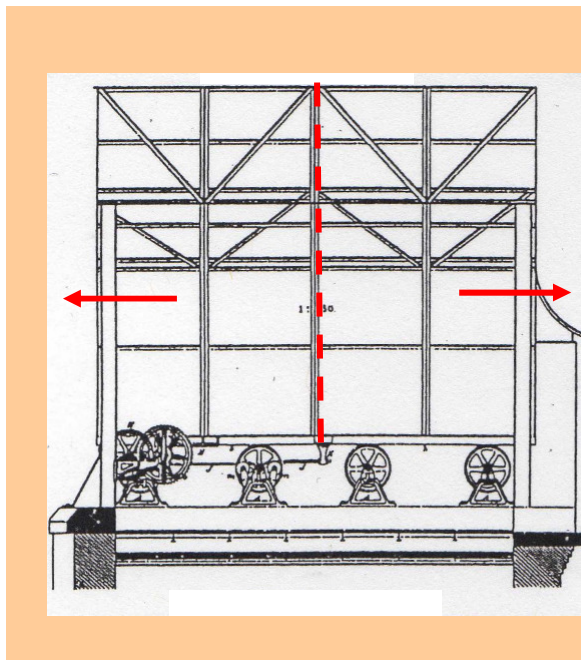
Meridianhaus, Konstruktionszeichnung, Seitenansicht, mit Markierung der Öffnung des Beobachtungsspaltes d. Laufräderkonstruktion
